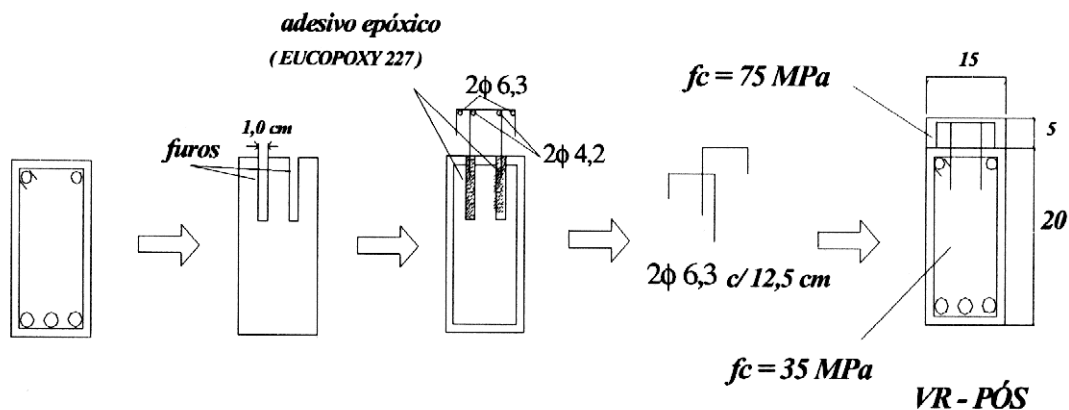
Esquema de Execução do Reforço da Viga VR – PÓS
